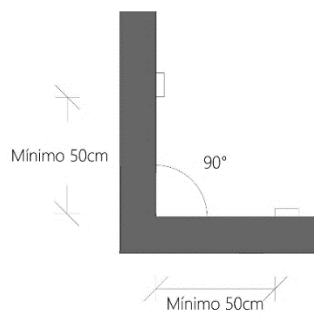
Separación a esquinas de elementos de accionamiento accesibles
